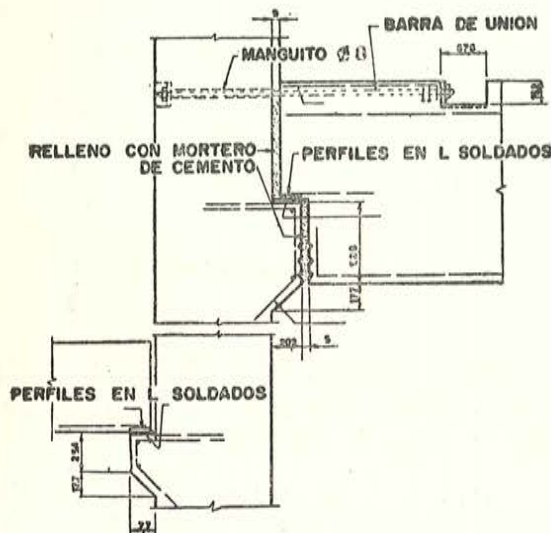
Unión de las vigas de la planta baja al soporte.
